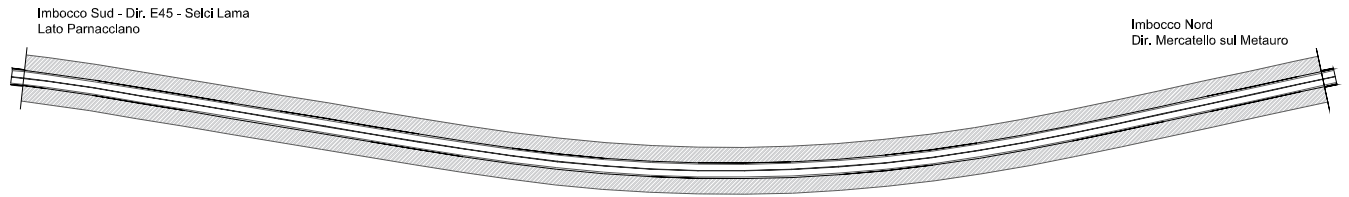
Planimetria gallerie S. Antonio canna nord (tratto lungo)
